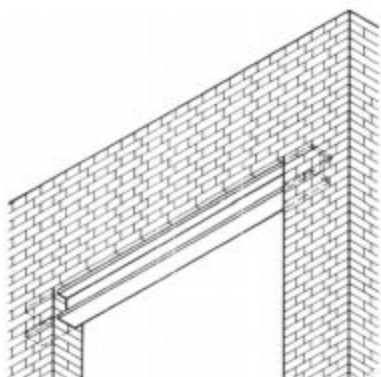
Abfangträger sind durch die Last der Mauer und ihre eigene Last belastet, oft auch noch durch Deckenauflagerlasten.
